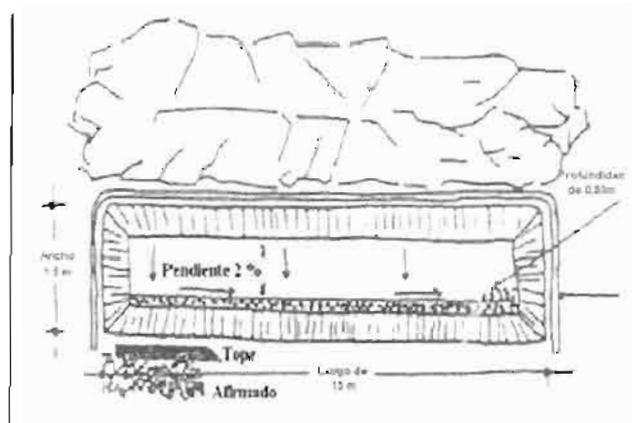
Esquema tipo del arreglo de zanja bordo prevista para el proyecto
